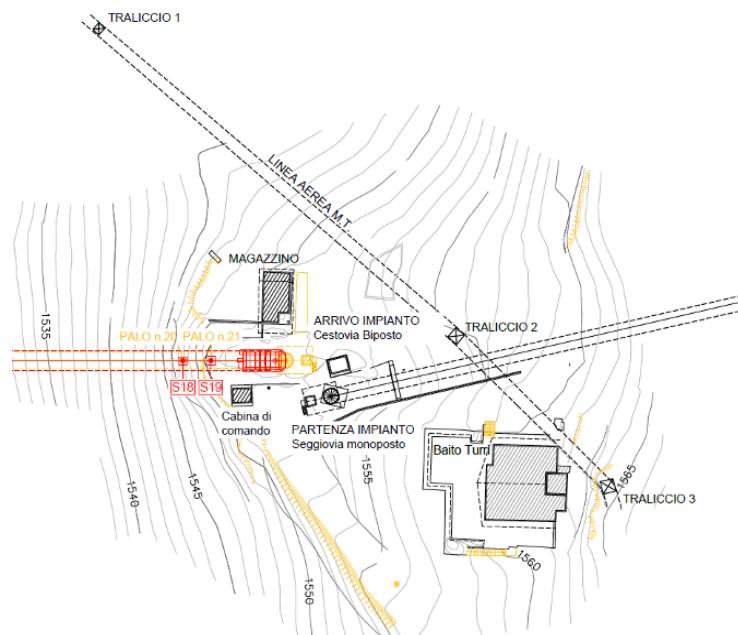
stazione tenditrice di monte (raffronto con impianto esistente - progetto ProAlpe).
